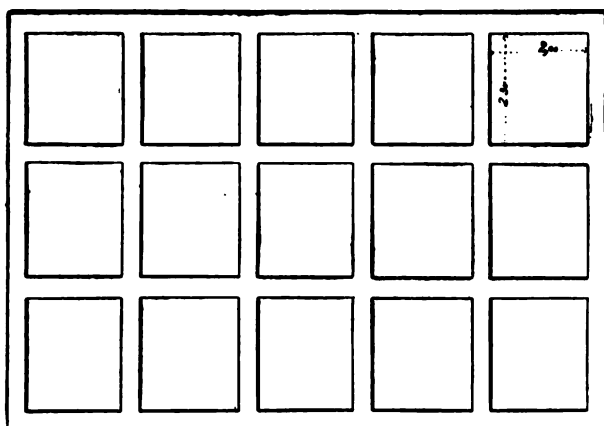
PLAN DE LA CASE A FERMENTER DE TRINIDAD
